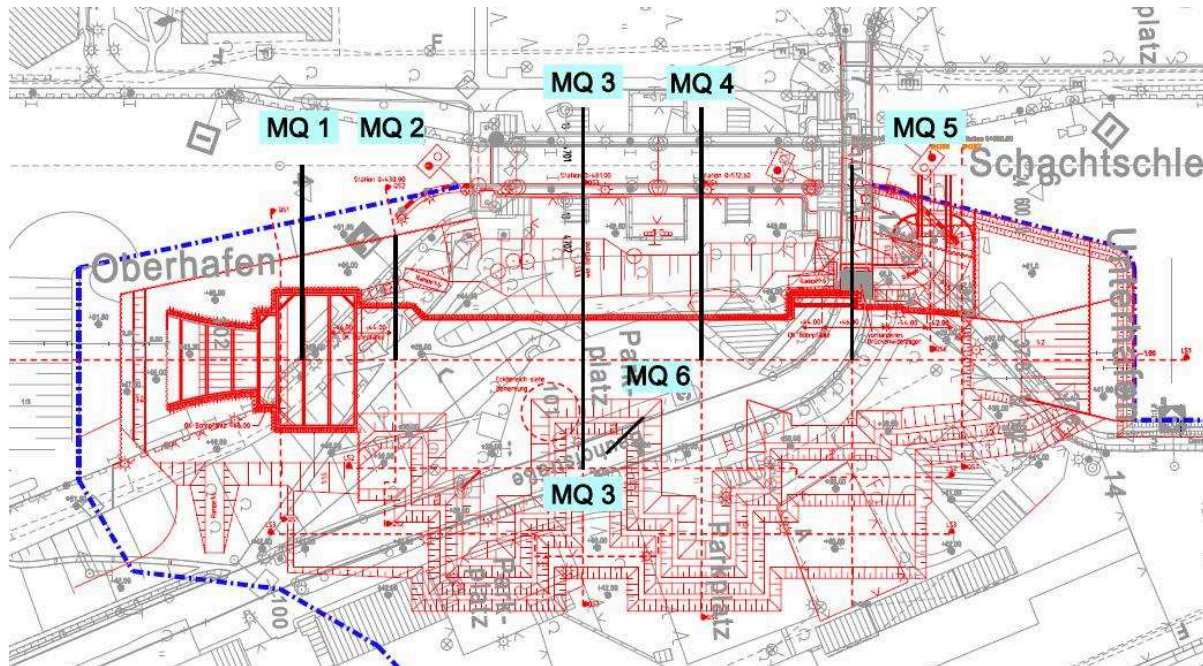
Lageplan der Baugrube mit den Messquerschnitten
